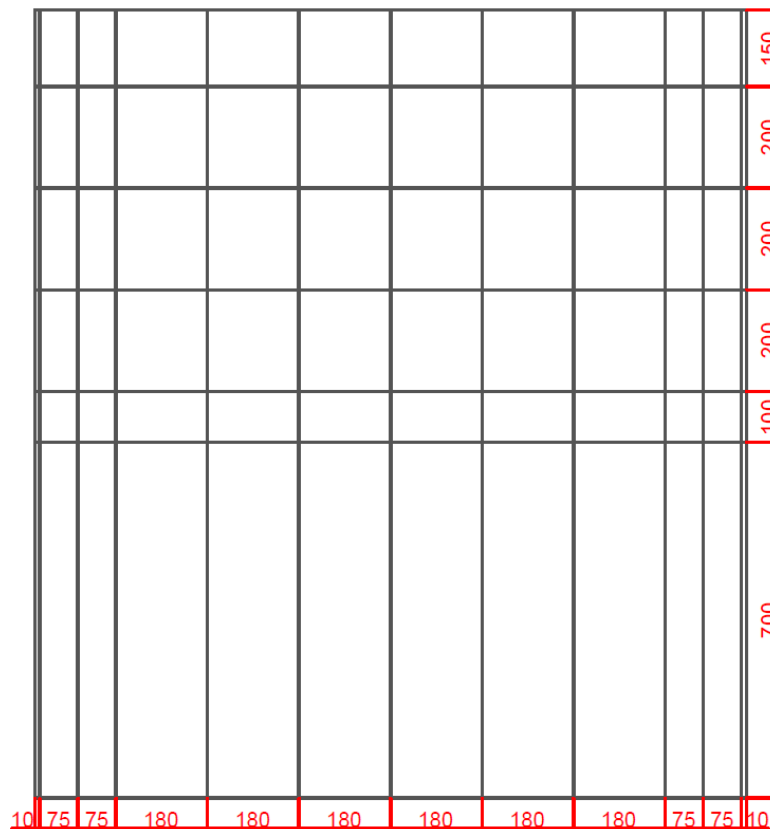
Discretización en milímetros de paneles y elementos de modelo E-SFI utilizado para muro convencional y alternativo.
